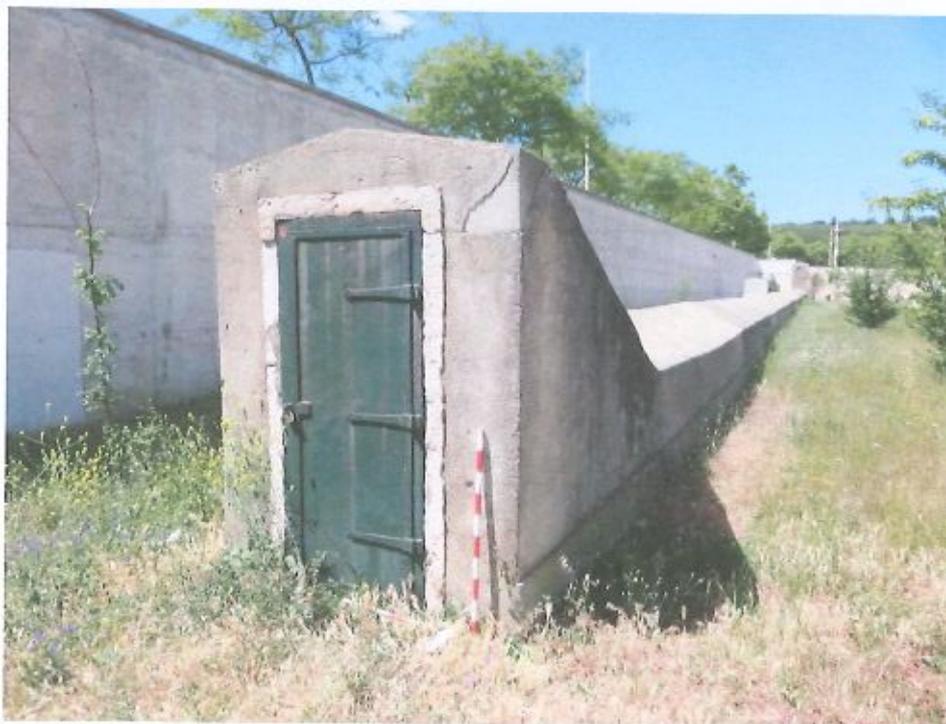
Aspetto da porta de entrada e troço de aqueduto. Vista Sudeste-Noroeste.
